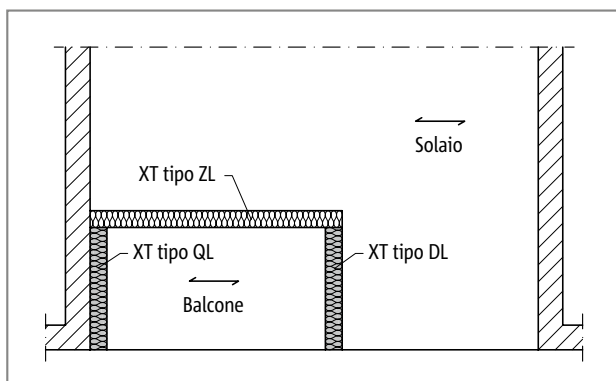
Schöck Isokorb® XT tipo DL, QL: solaio monodirezionale
